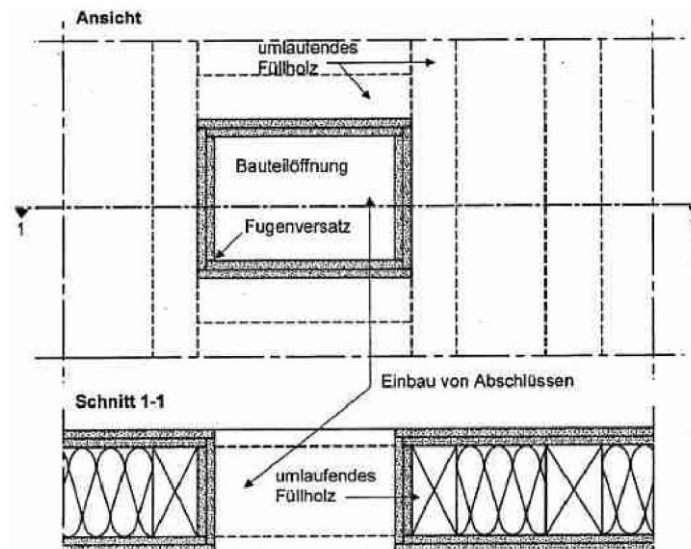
Prinzipskizze zur Ausführung der Laibungsbekleidung einer Öffnung gemäß MHolzBauRL [6]
